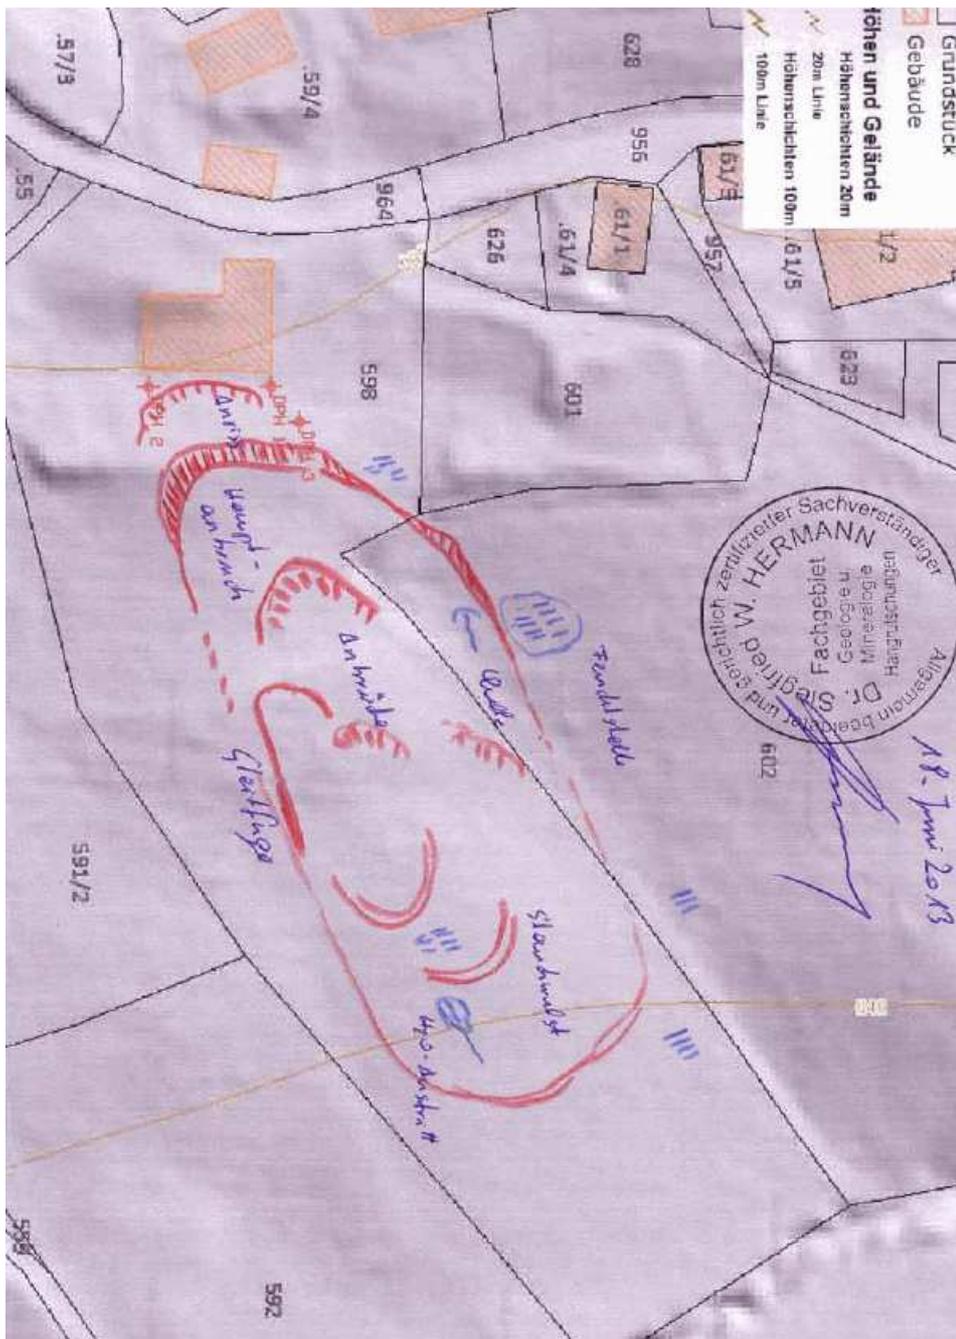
Darstellung der Hangrutschung im Lageplan²⁶⁰
